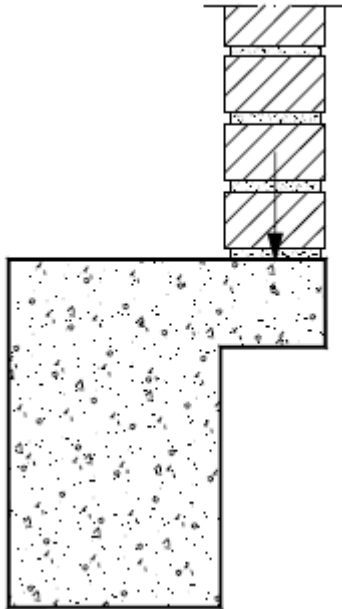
Vigas com carregamentos excêntricos [13]
